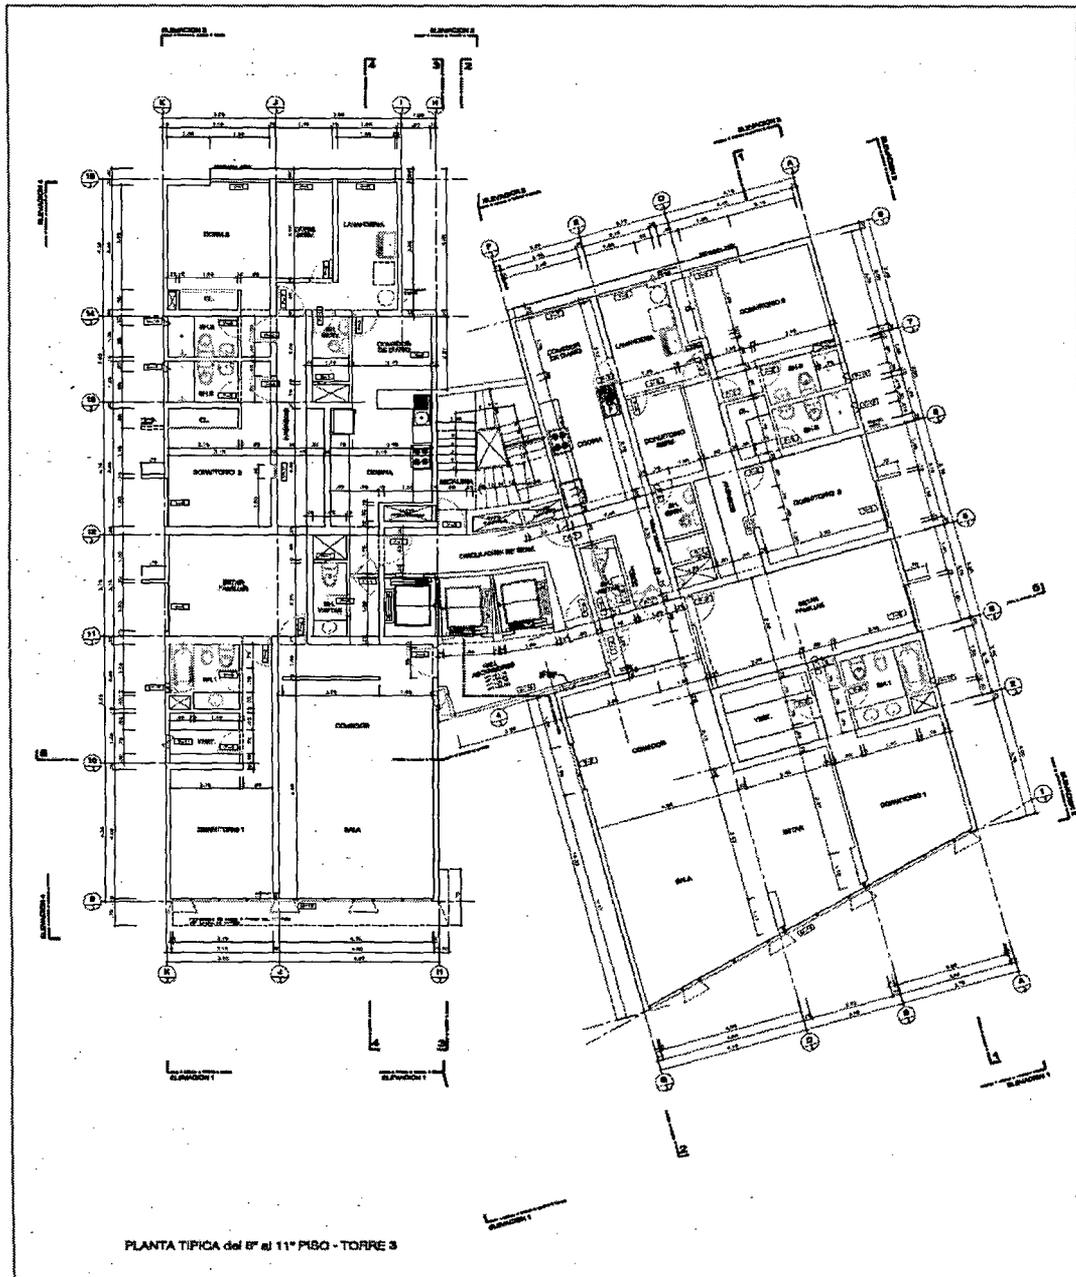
Planta Típica Torre 3 del proyecto Golf Millenium
